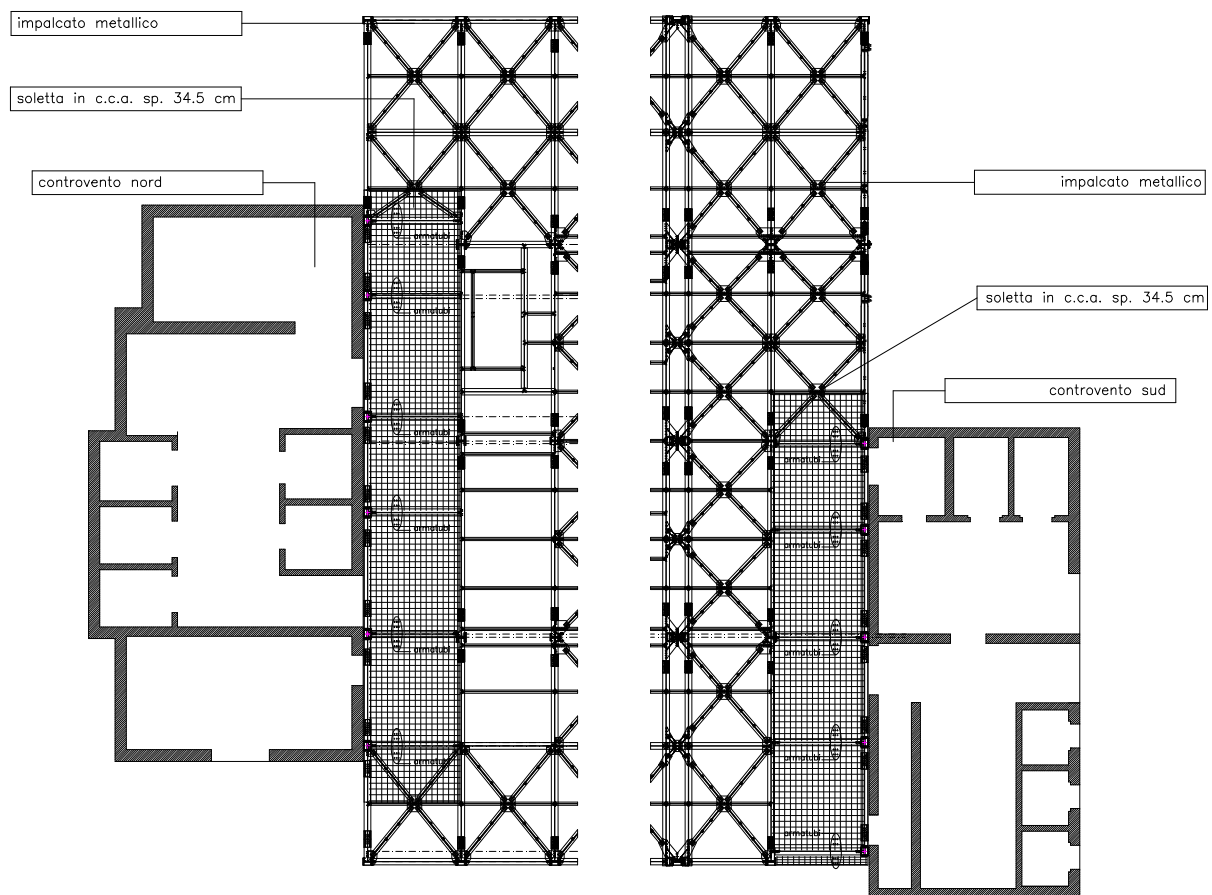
Rappresentazione in pianta del sistema di collegamento
